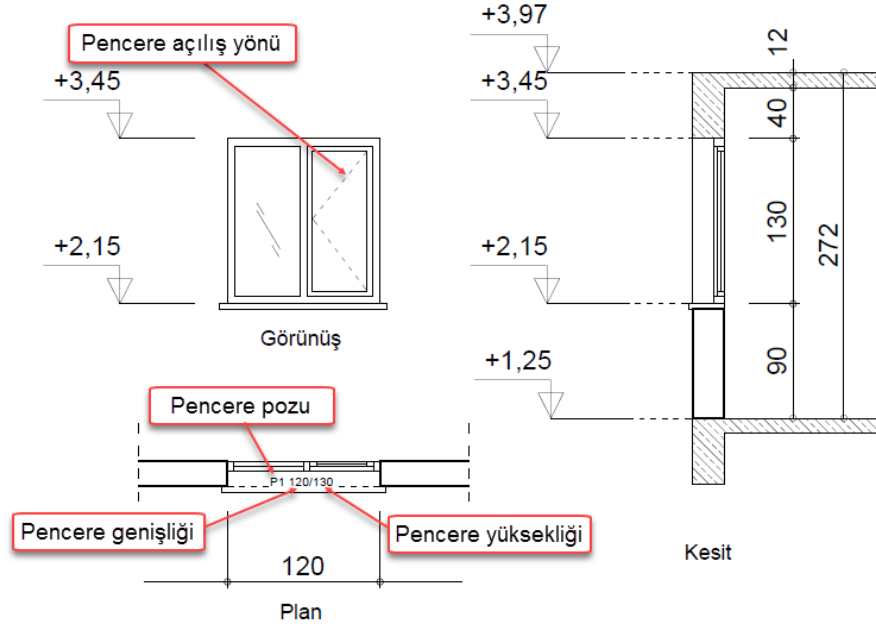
Plan, kesit ve görünüşlerde kotlu ölçülendirme işareti
